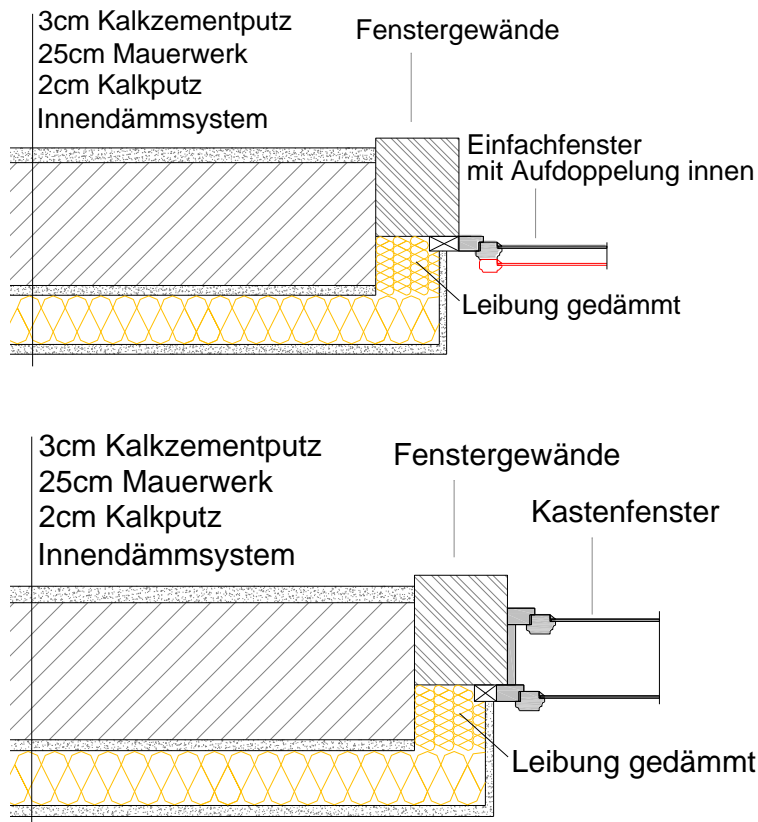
Fensterdetailanschluss Leibung bei Einfachfenster mit Aufdoppelung innen (rechts) und Kastenfenster (links) bei Innenwärmedämmung
